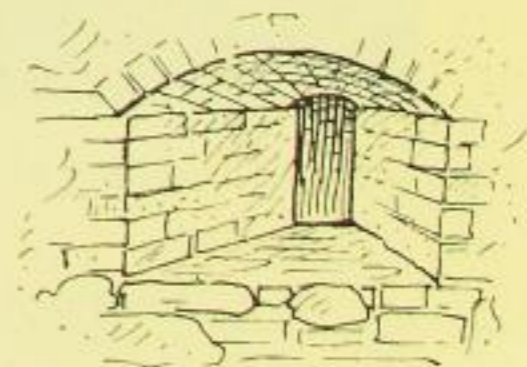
Bernstadt, Kirche, Fenster im Dachraum.
